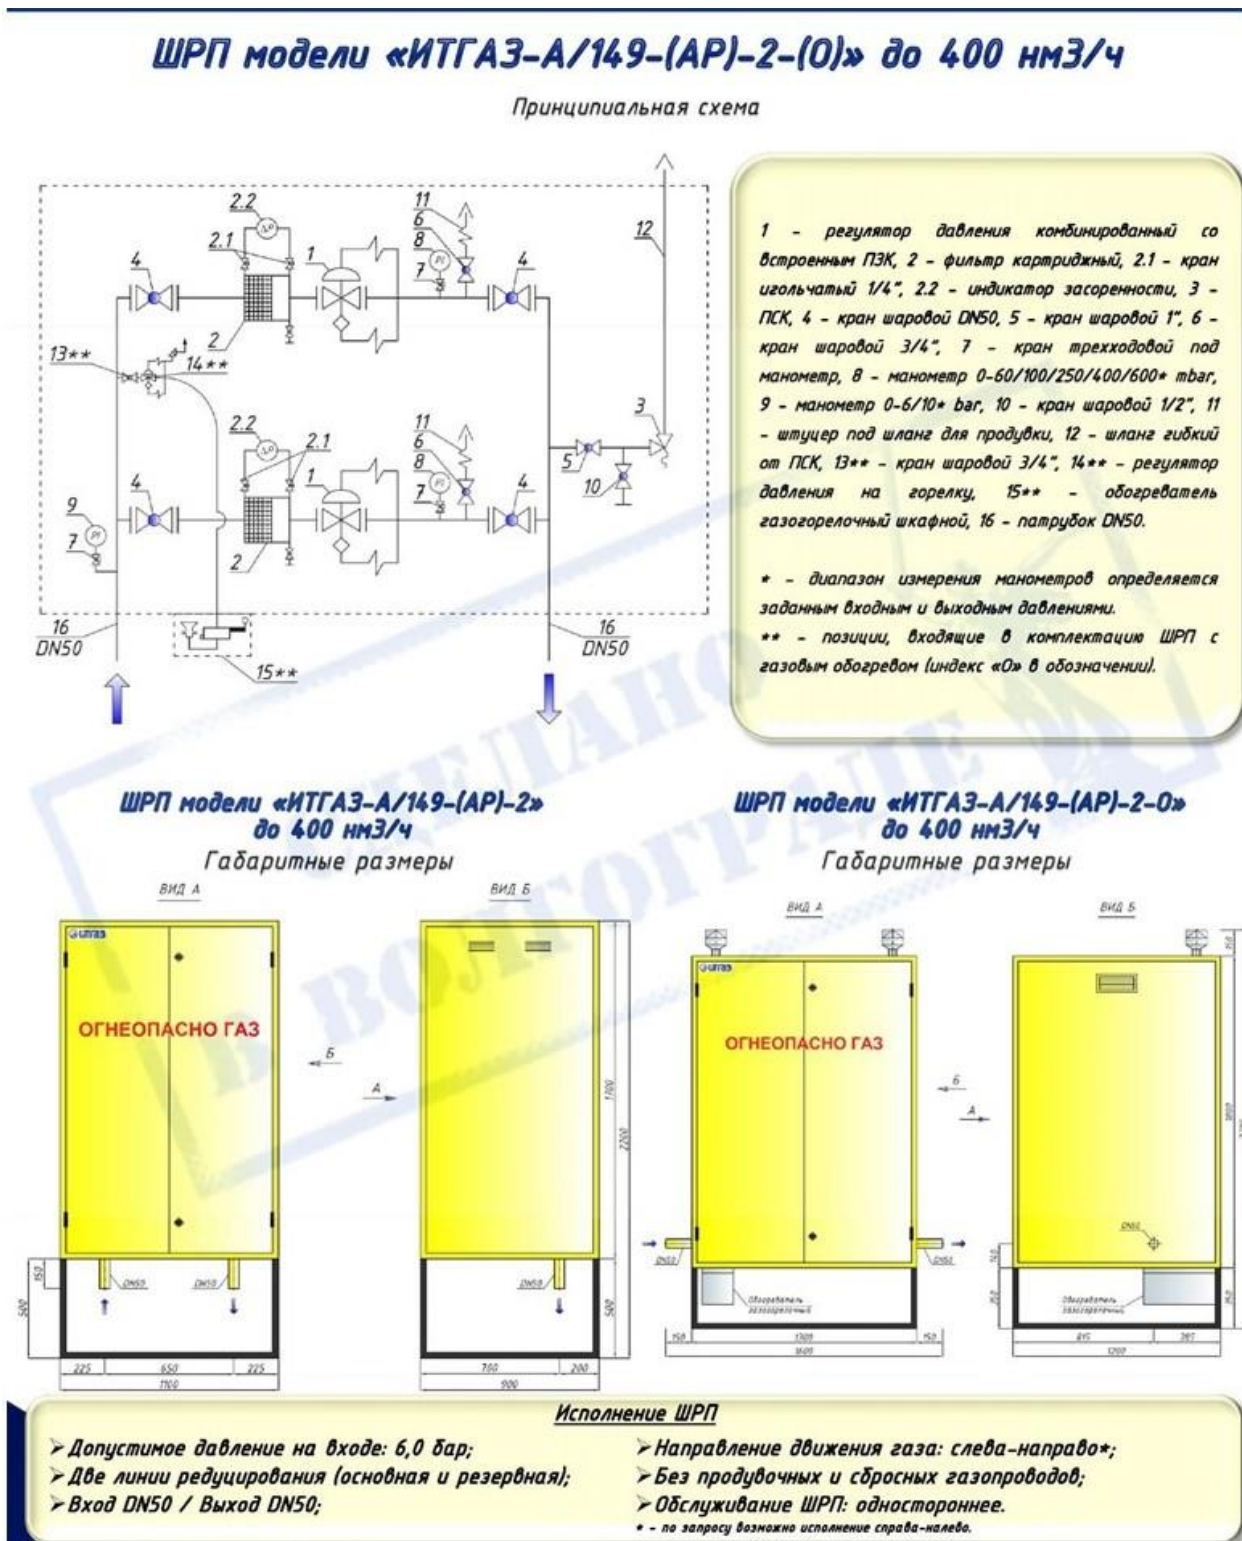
Пневматическая схема и габаритные размеры ШРП «ИТГАЗ-А/149-2»
